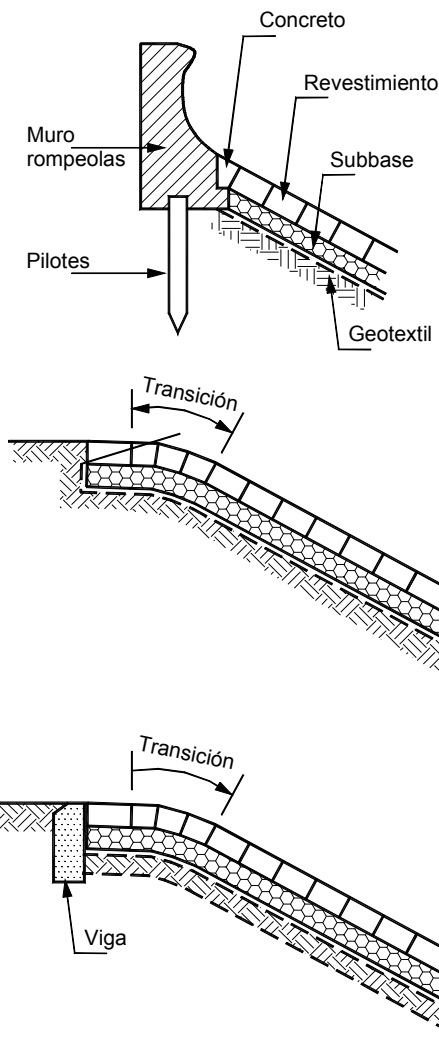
Detalles de la cresta de un revestimiento con bloques de concreto.
